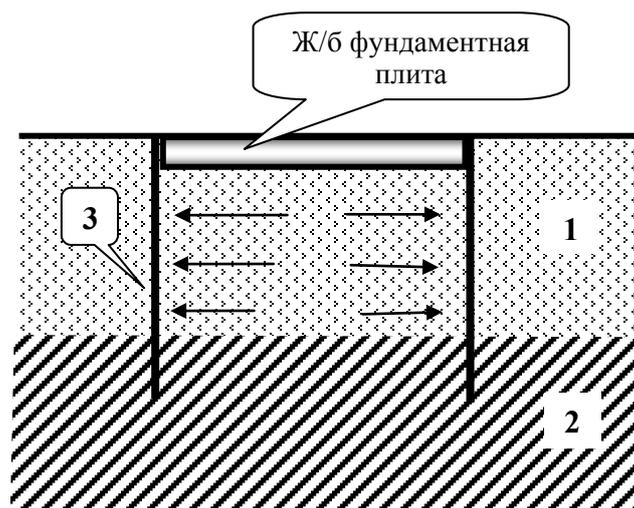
Схема конструктивного усиления с использованием шпунтовой обоймы:
